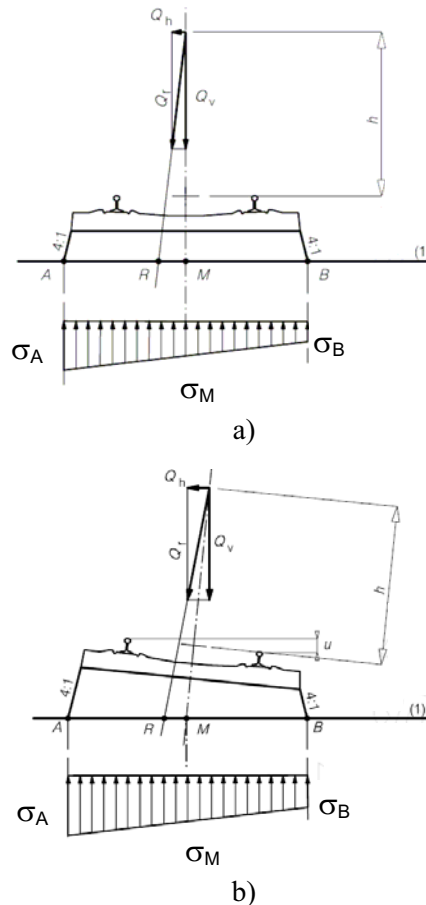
Distribuição transversal da carga pela travessa e pelo balastro num troço de via:
